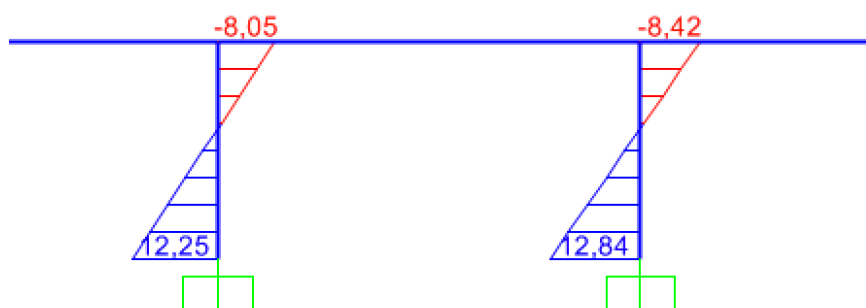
Esfuerzos cortantes en las columnas más solicitadas, correspondientes a las vigas longitudinales inferiores
